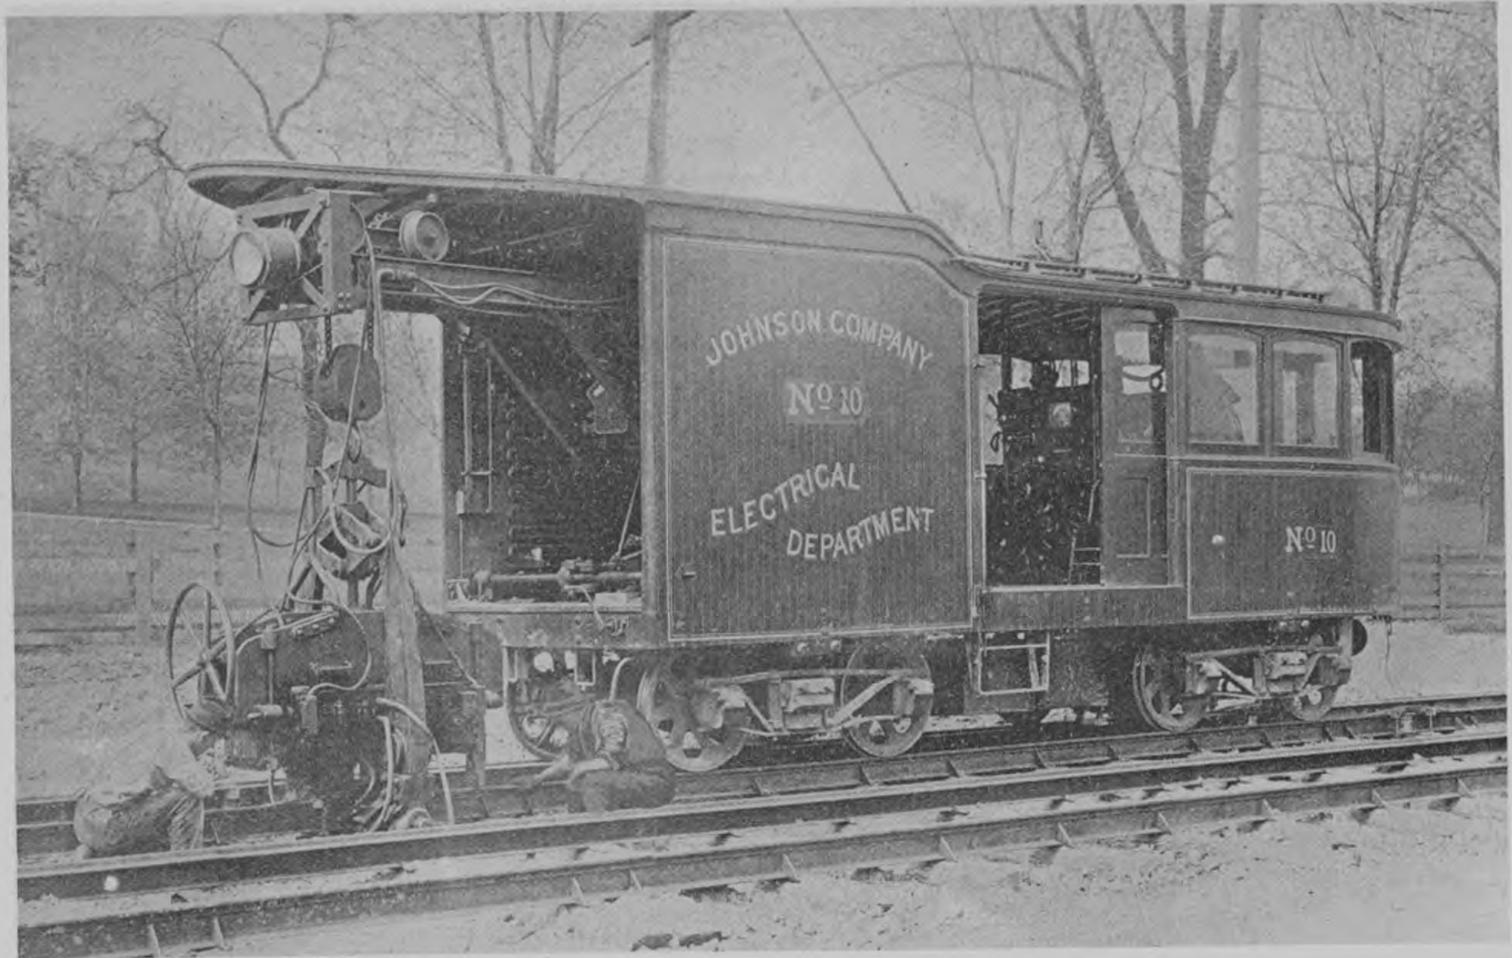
WAGON ÉLECTRIQUE POUR LA SOUDURE DES RAILS
